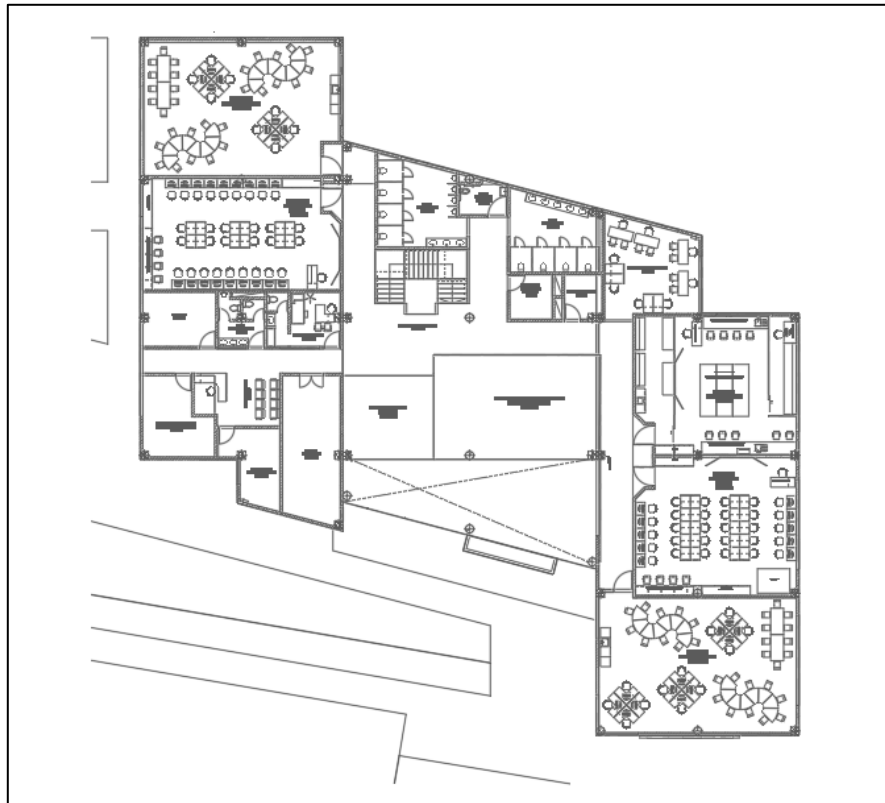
Plantas Arquitectónicas del proyecto Nivel 2.
